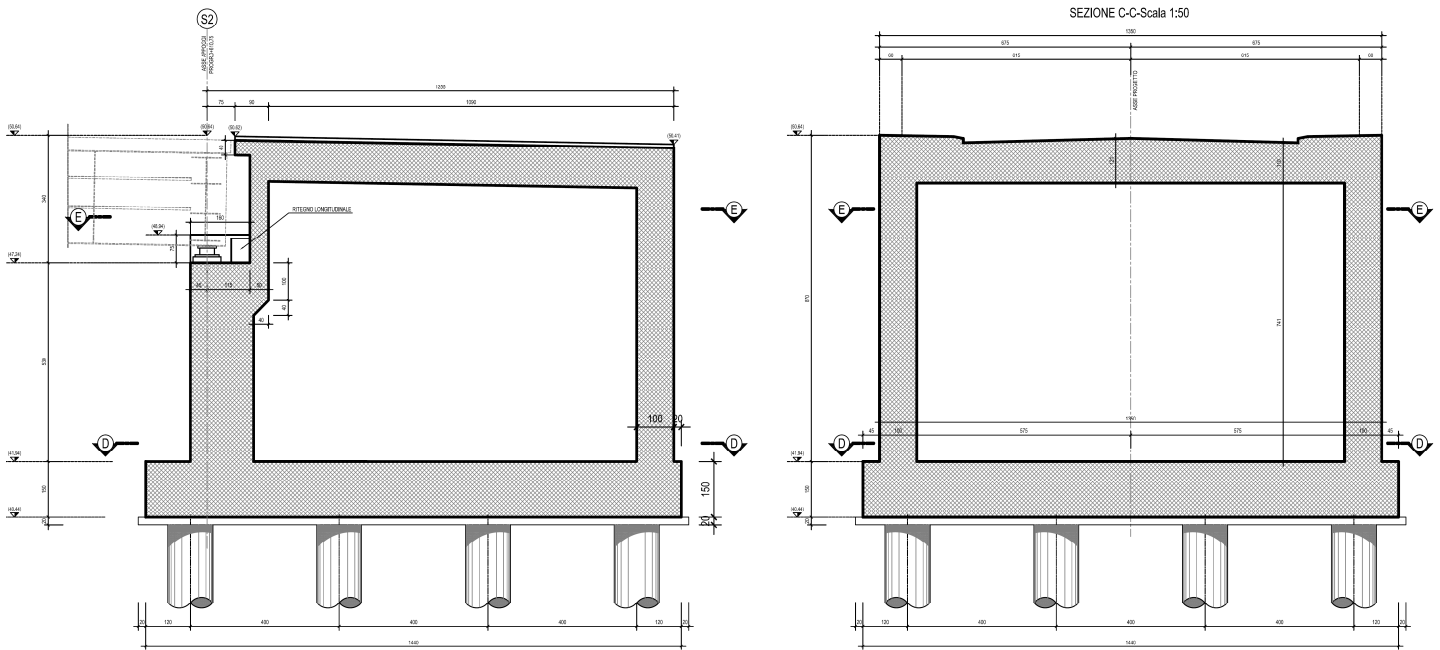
Sezioni longitudinale e trasversale spalla S2
